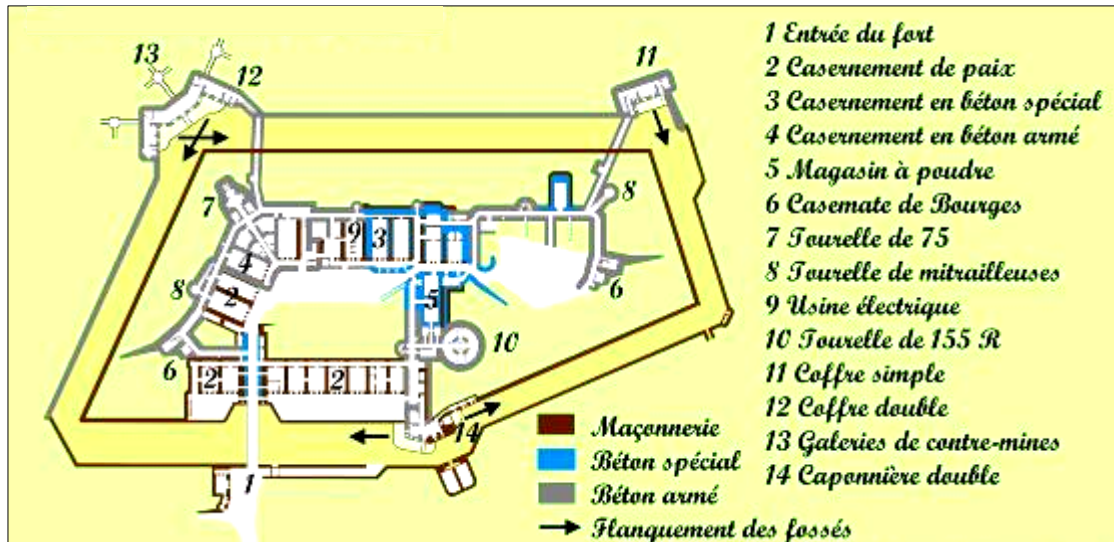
Plan du fort d'Uxegney de 1914. France
